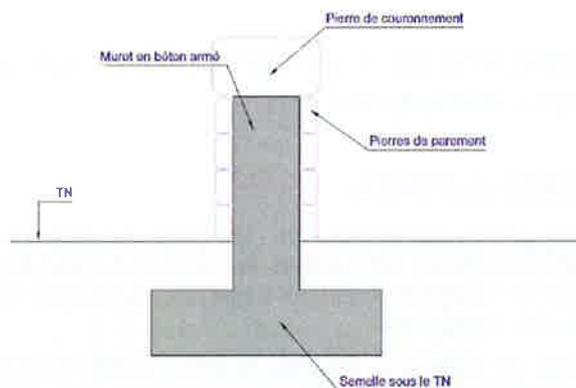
Coupe-type du muret maçonné dans le prolongement du quai de la Roquette
